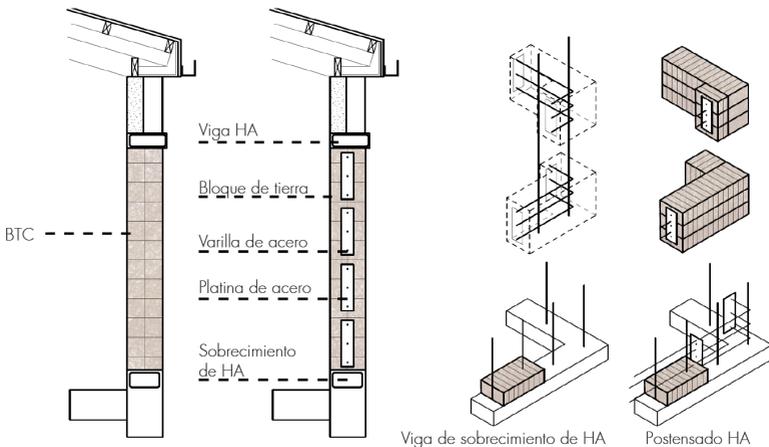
| El uso de los bloques en sinergia con elementos estructurales de acero y hormigón. | Fuente: Autoría Propia (2024).
